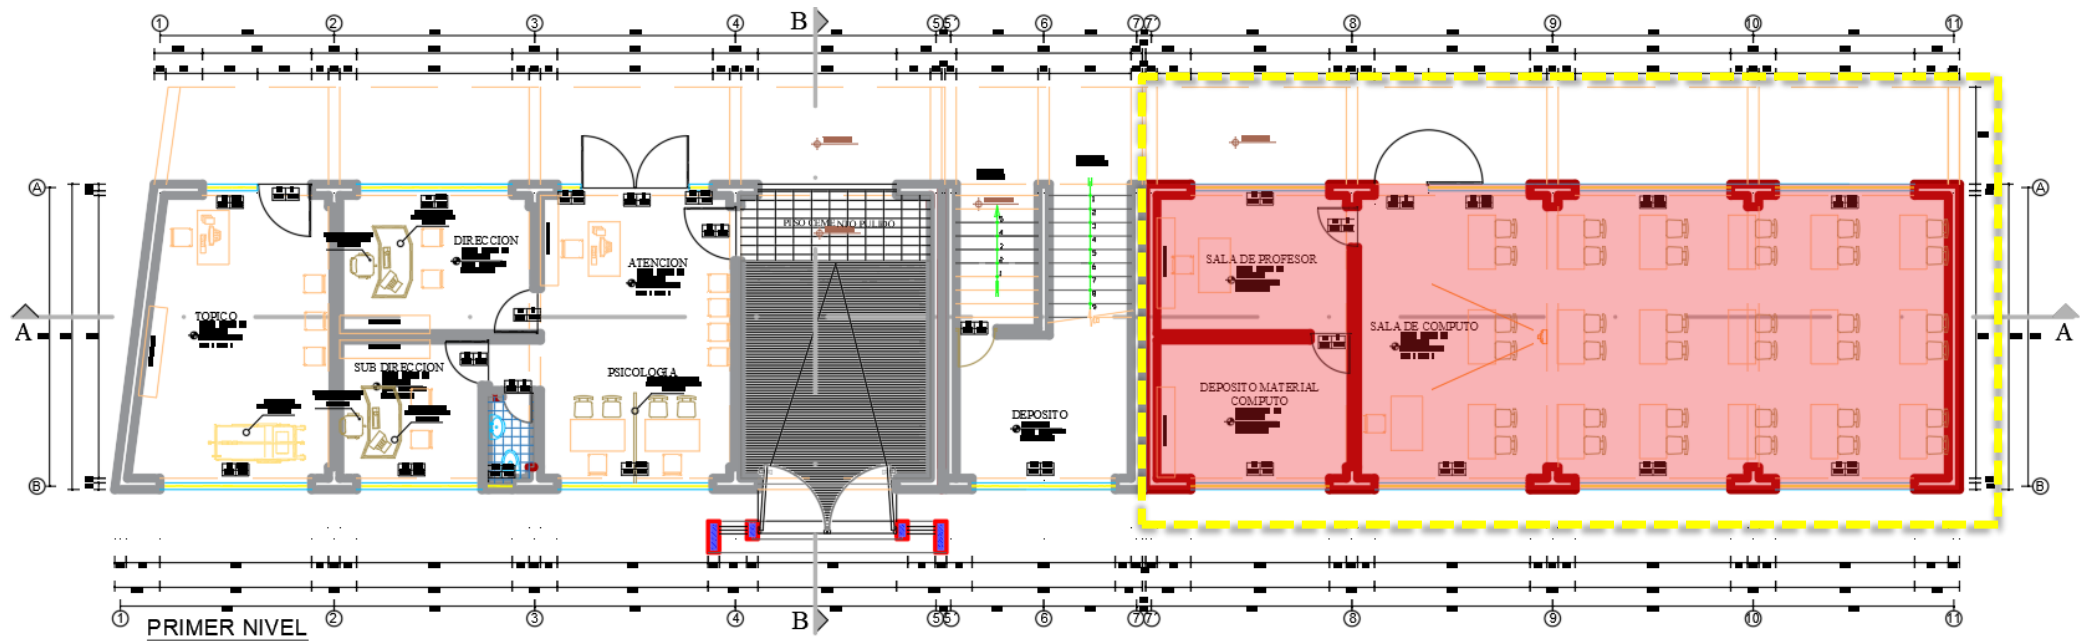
Vista en planta, piso 1, bloque 2 del pabellón A - I.E. N°40092
